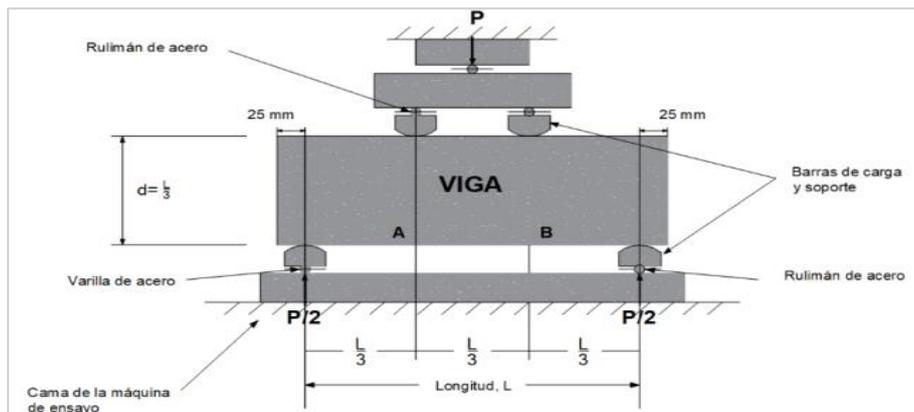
Esquema de ensayo a flexión de vigas de concreto
